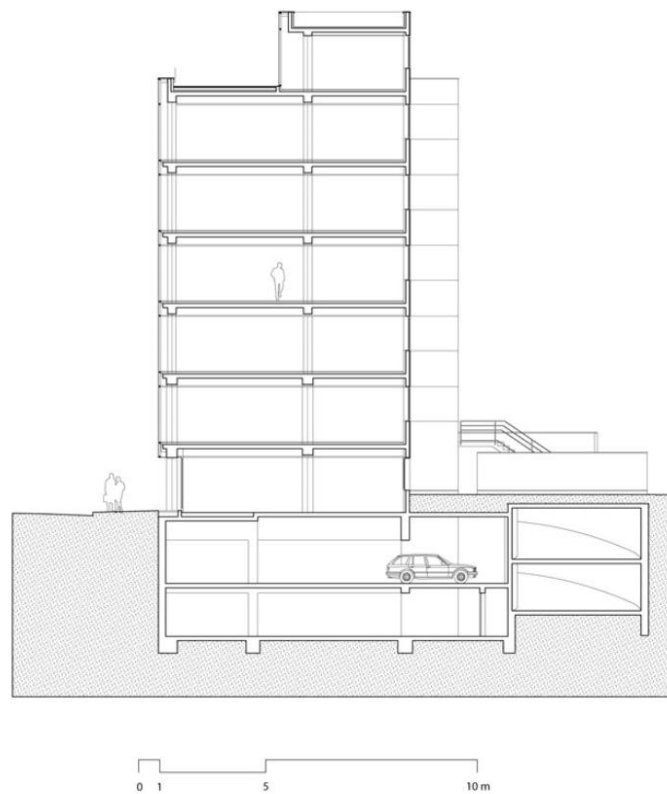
Corte transversal del Centro Empresarial Gambetta, Francia. Recuperado de archdaily.pe
